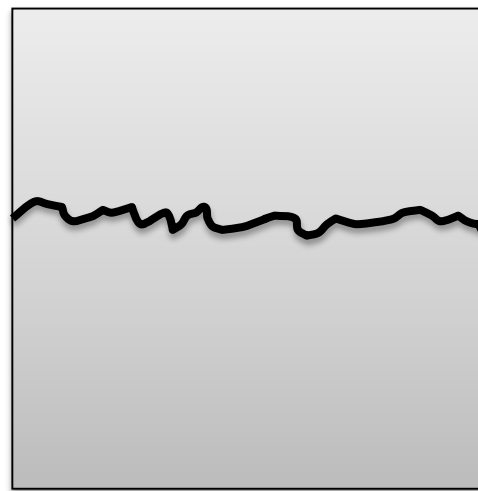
Характерные трещины в месте устройства рабочего шва плиты перекрытия после распалубливания.
